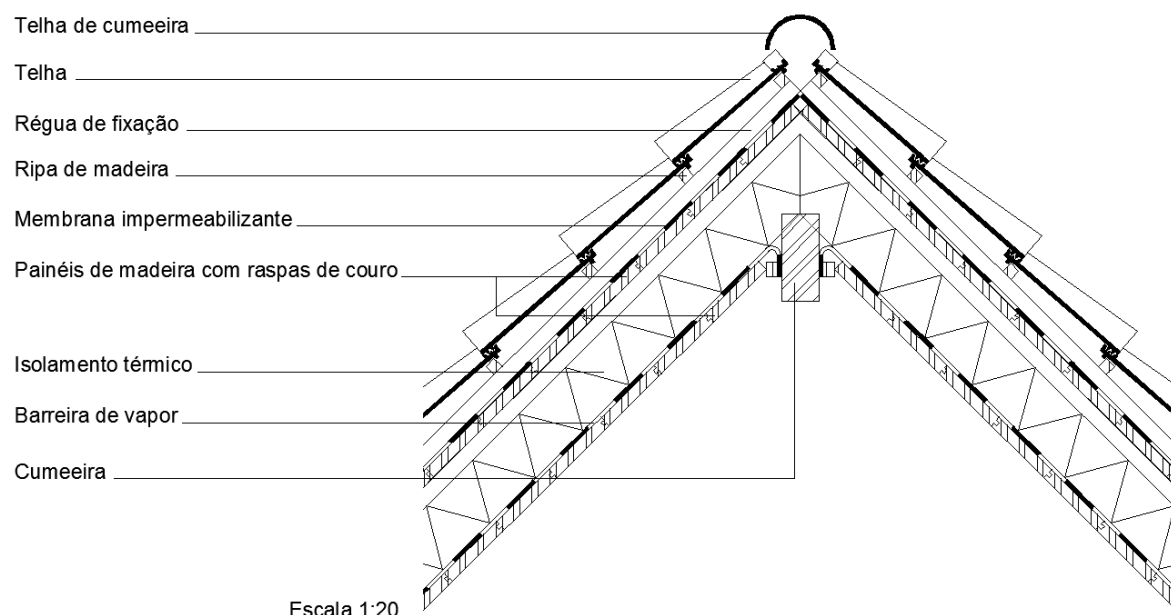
Detalhe construtivo de cobertura inclinada com utilização de painéis de fibras de madeira com raspas de couro
